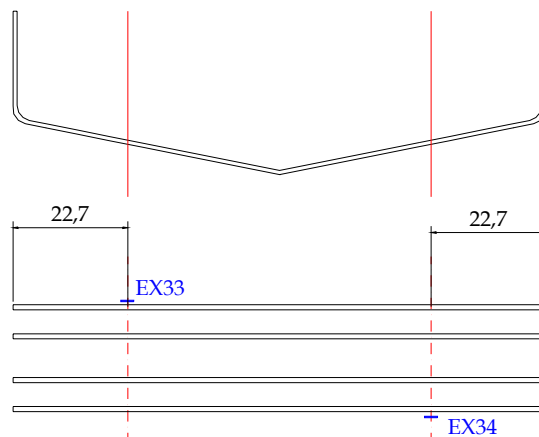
Instrumentação da armadura do consolo (dimensões em cm).
